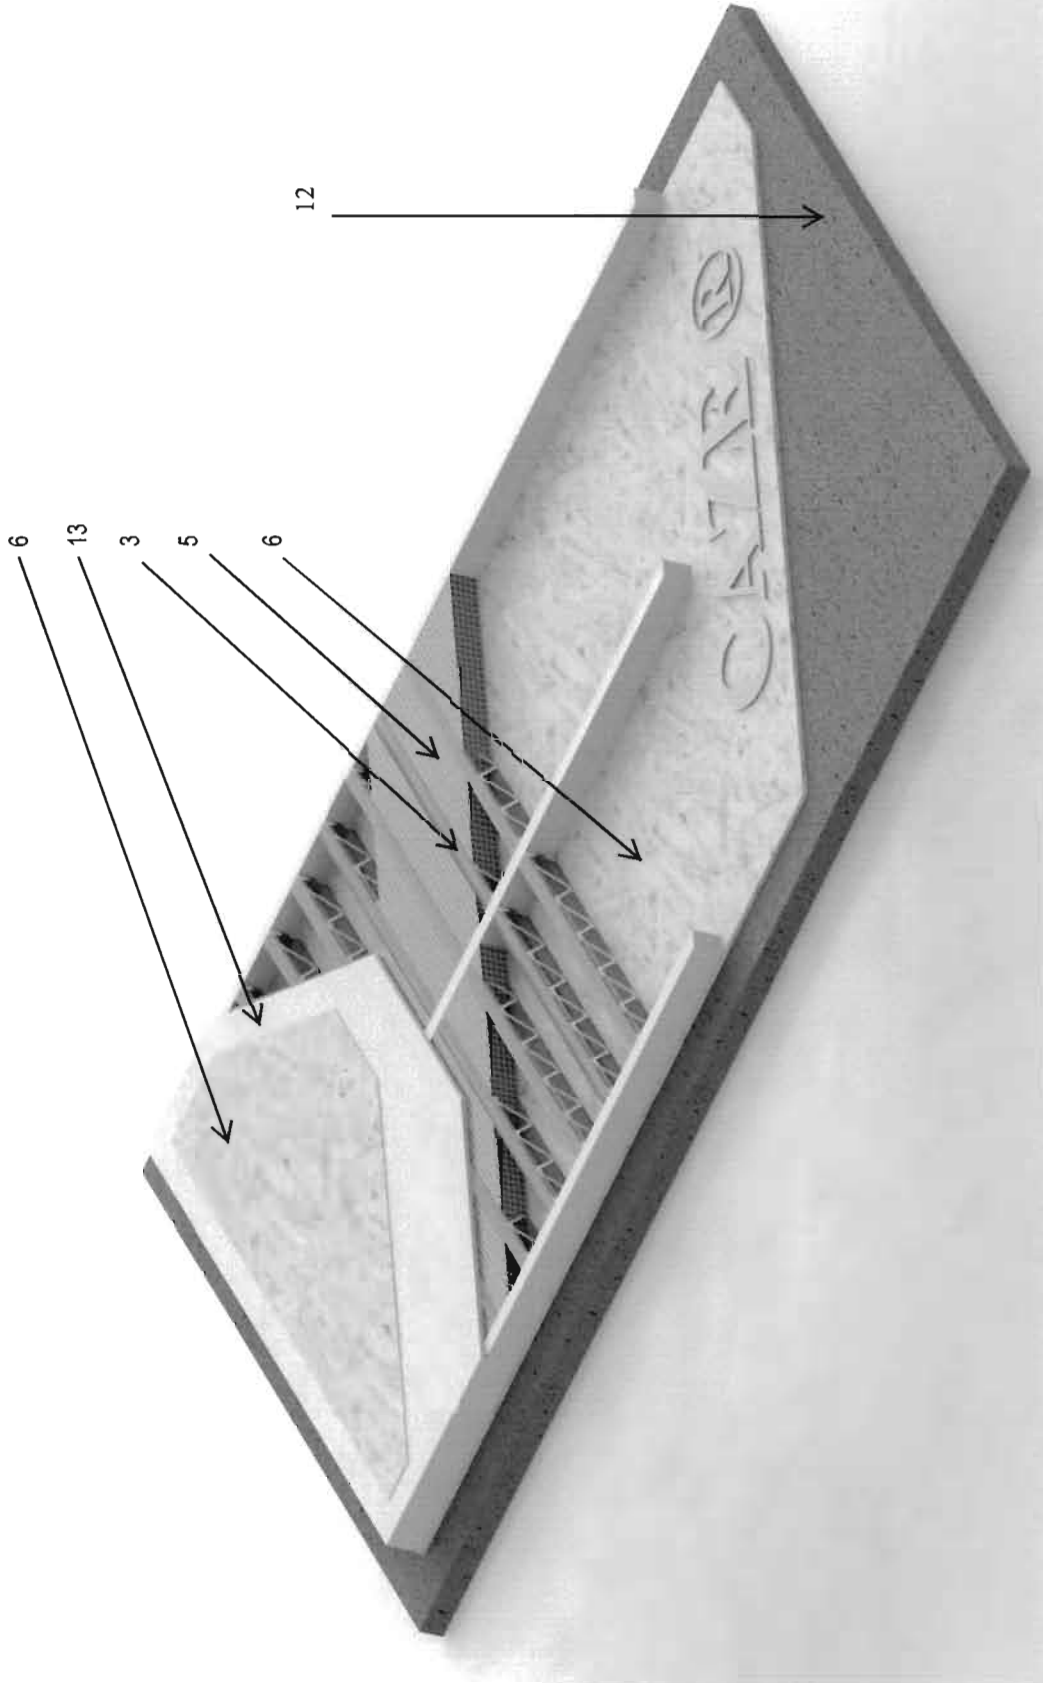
STRUCTURĂ MULTIPLĂ DIN LEMN ȘI METAL CAZE®
